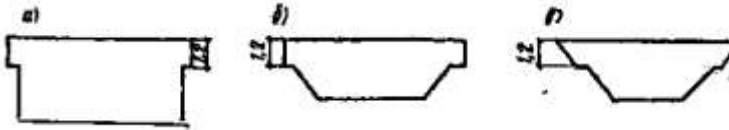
Схеми поперечного розрізу ванн басейнів зі стінами:
